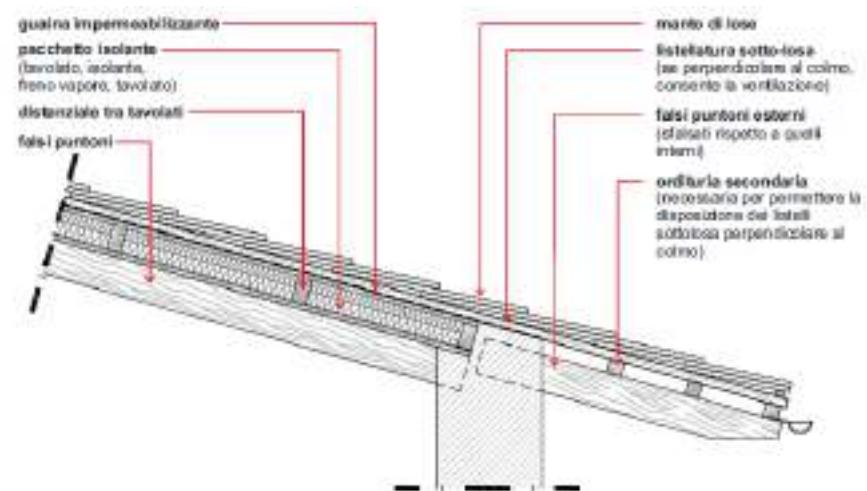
struttura a falsi puntoni con ventilazione sotto losa
